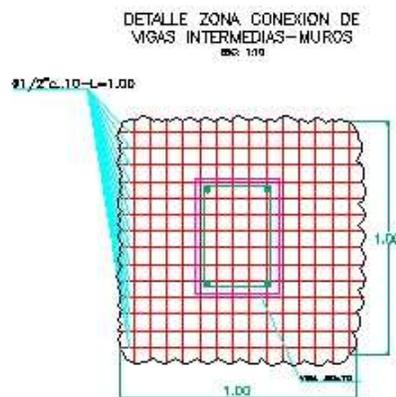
Recomendaciones de refuerzo en muros, zona de vigas
